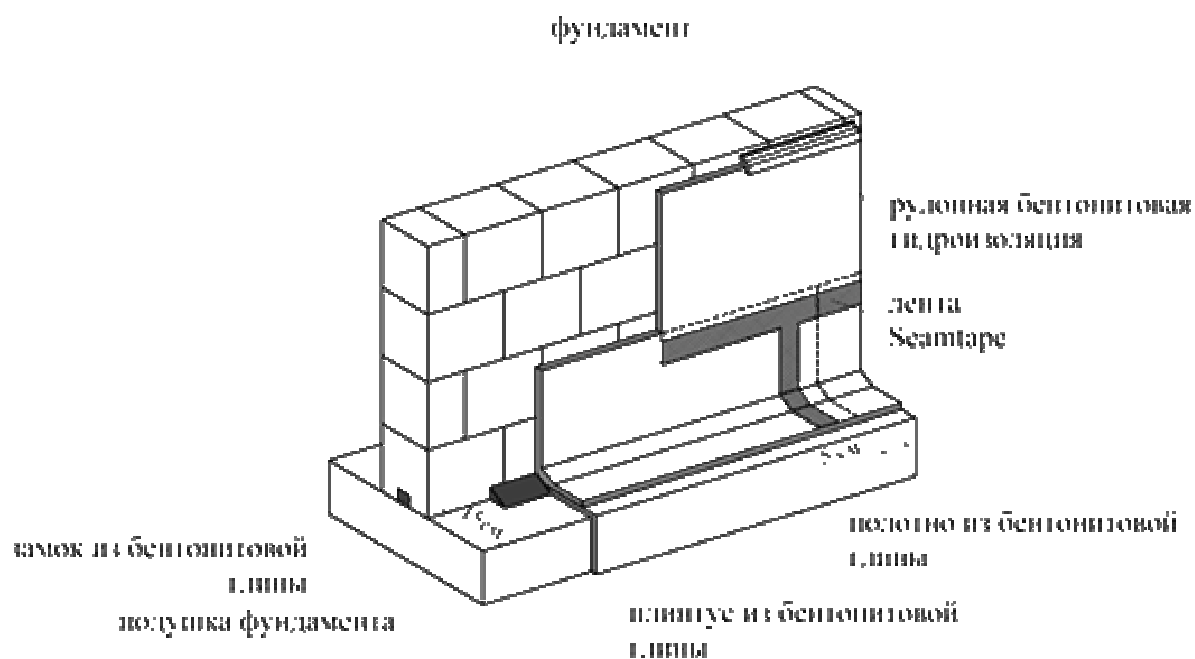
Укладка гидроизоляционных матов на вертикальную поверхность фундамента из блоков с креплением верха планкой и бетонитовой шпатлёвкой
